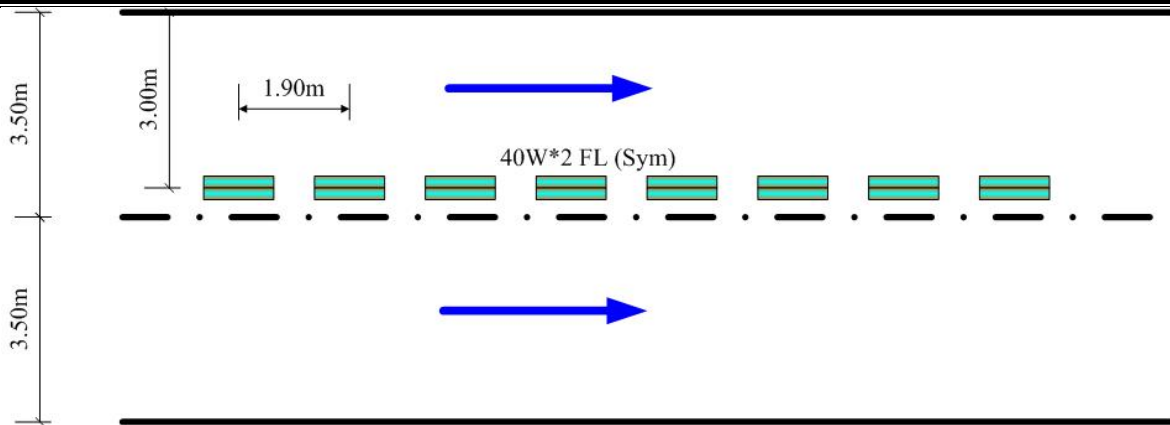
雪山隧道燈具安裝平面示意圖
